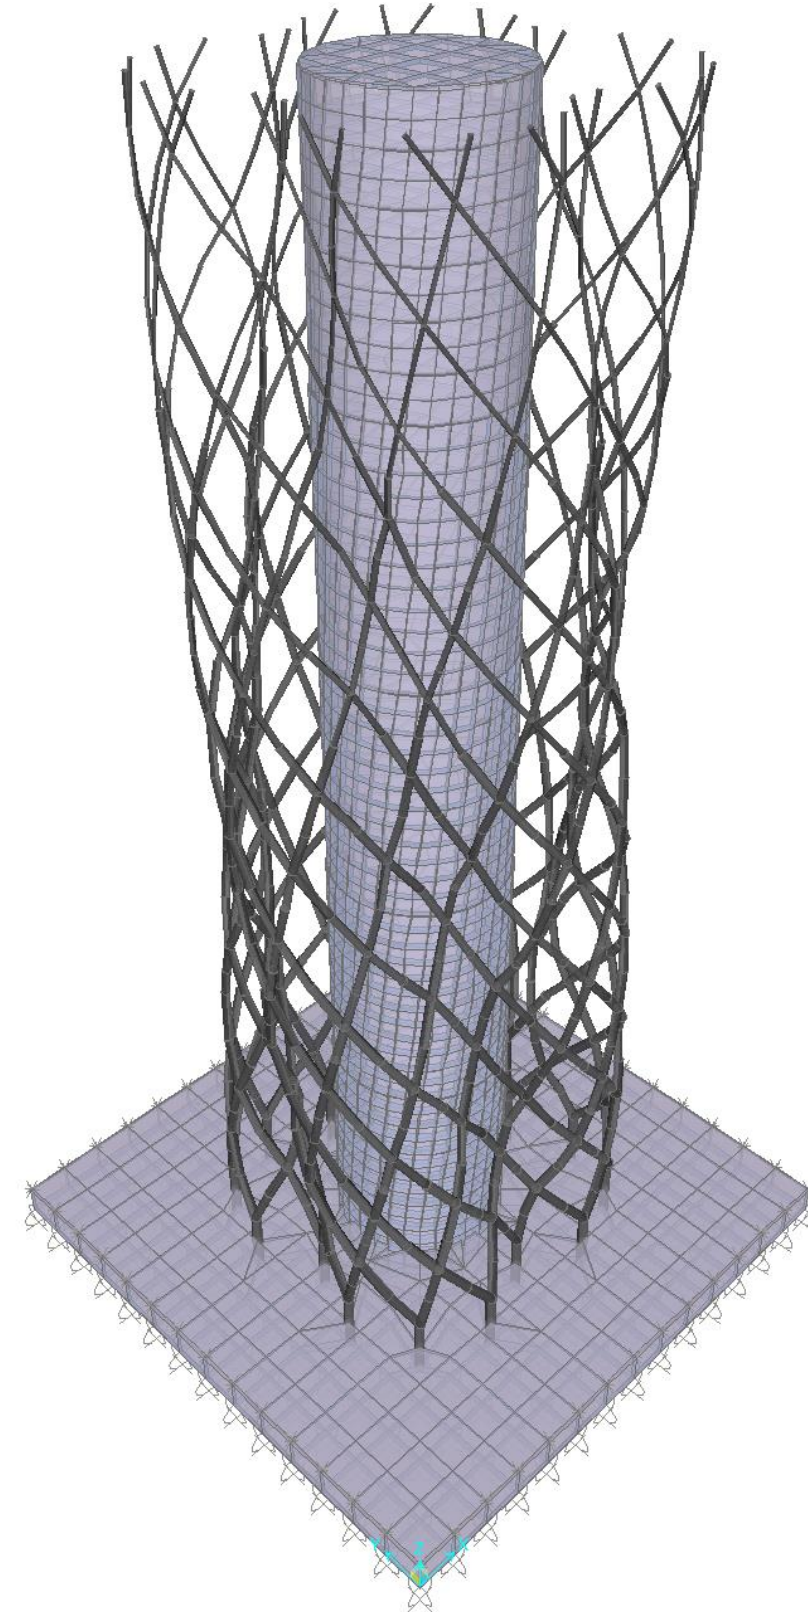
En esta imagen se pueden ver el tubo exterior, formado por un entramado de perfiles metálicos, y el interior que es un muro de hormigón armado de sección decreciente en sentido ascendente.
